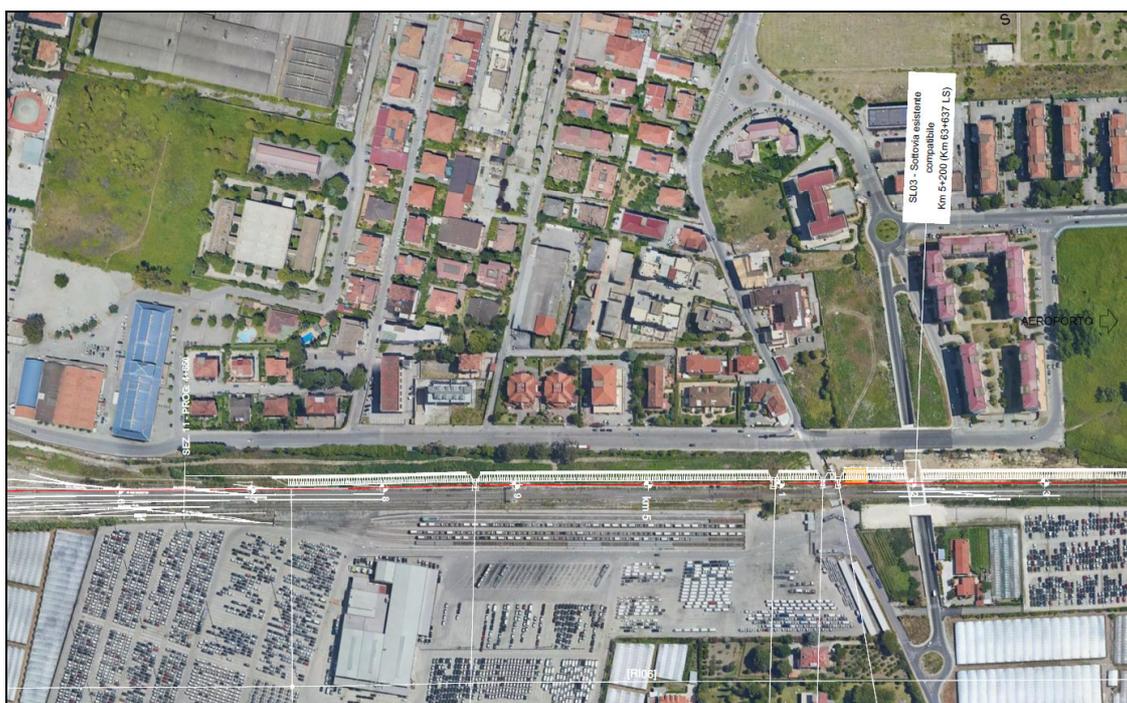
Stralcio planimetria su ortofoto in uscita dalla stazione di Pontecagnano
